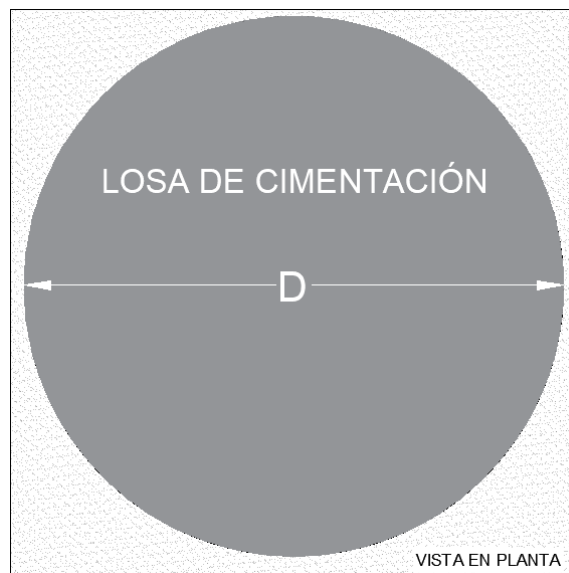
Desplante de losa en estrato resistente y presencia de estrato débil por debajo, vista en planta.
